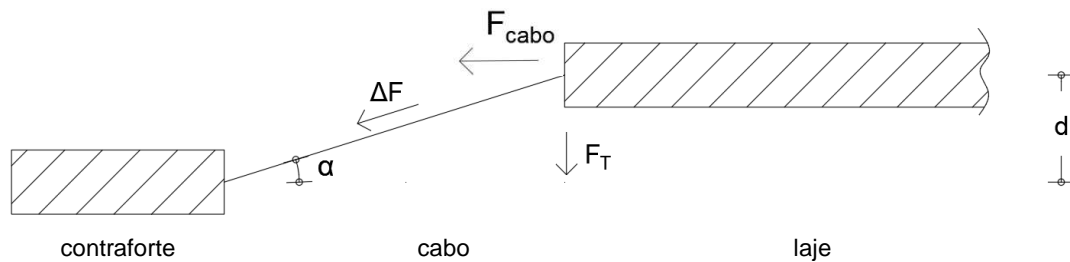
Esquema em planta do troço de cabo na ligação entre a laje de cobertura e o contraforte.
